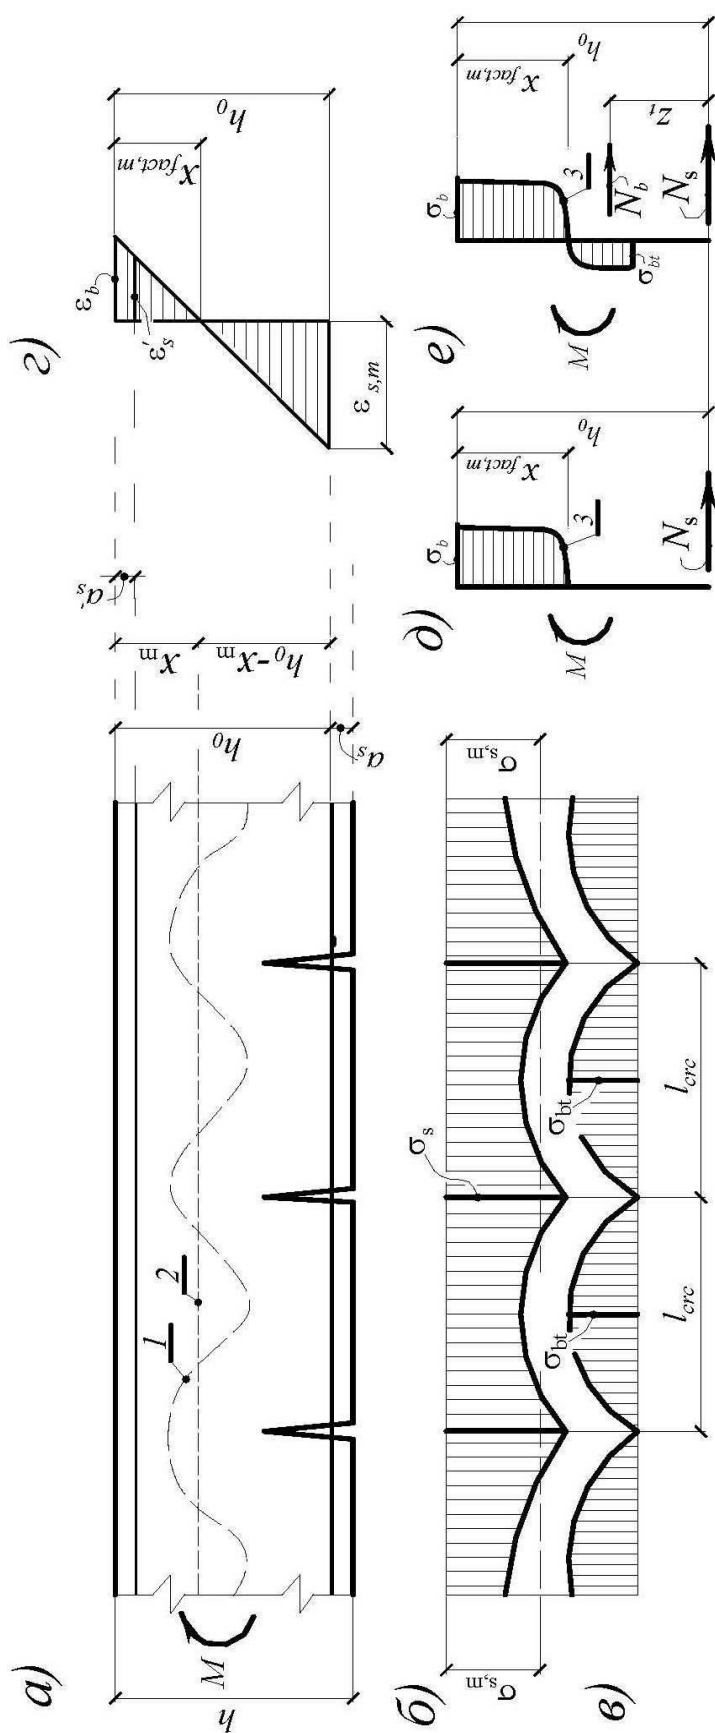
Типичные картины деформирования бетона и арматуры в железобетонном элементе с трещинами по теории В. И. Мурашева и Я. М. Немировского: а – схема образования трещин; б, в – эпюры напряжений в растянутой арматуре и растянутом бетоне; г – гипотеза плоских сечений; д – внутренние усилия в сечении с трещиной по теории В. И. Мурашева; е – внутренние усилия в сечении с трещиной по теории Я. М. Немировского с учетом работы растянутого бетона над трещиной
